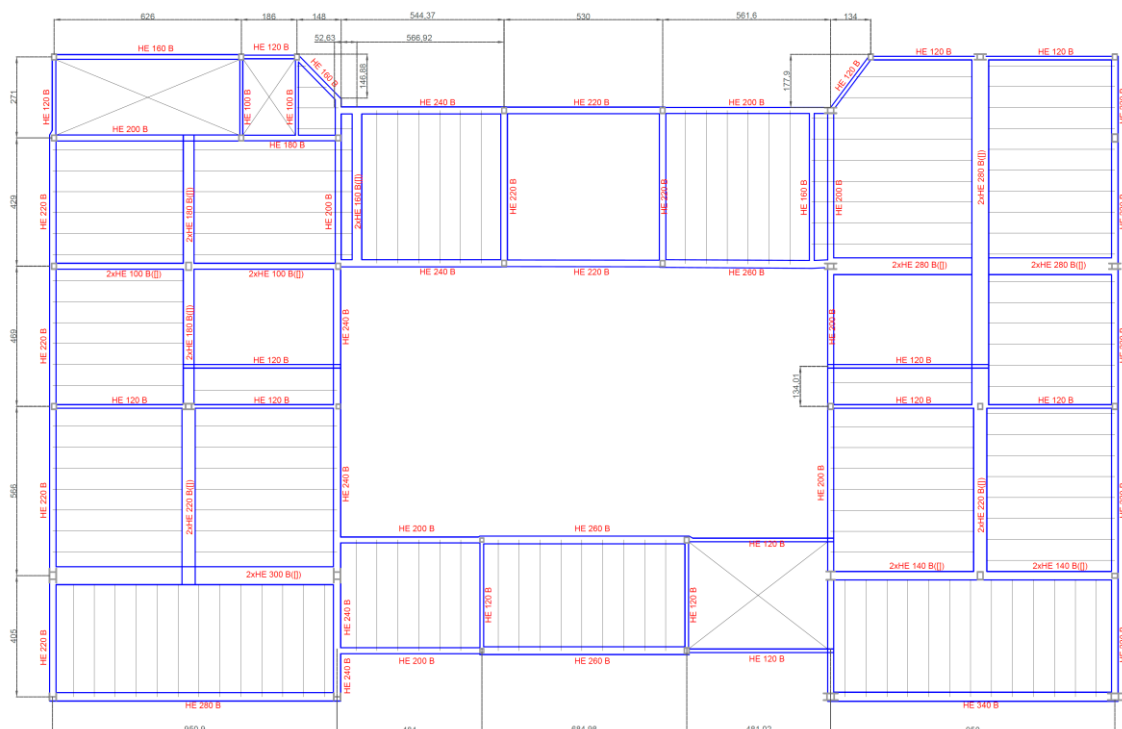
Disposición en planta del forjado objeto de estudio. (Fuente: elaboración propia)
